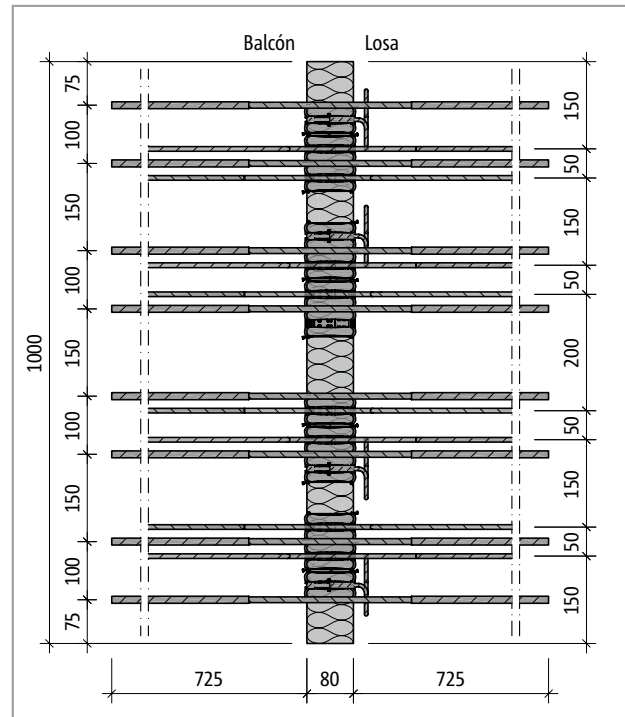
Schöck Isokorb® T tipo K-M6-VV1: Plano del producto
